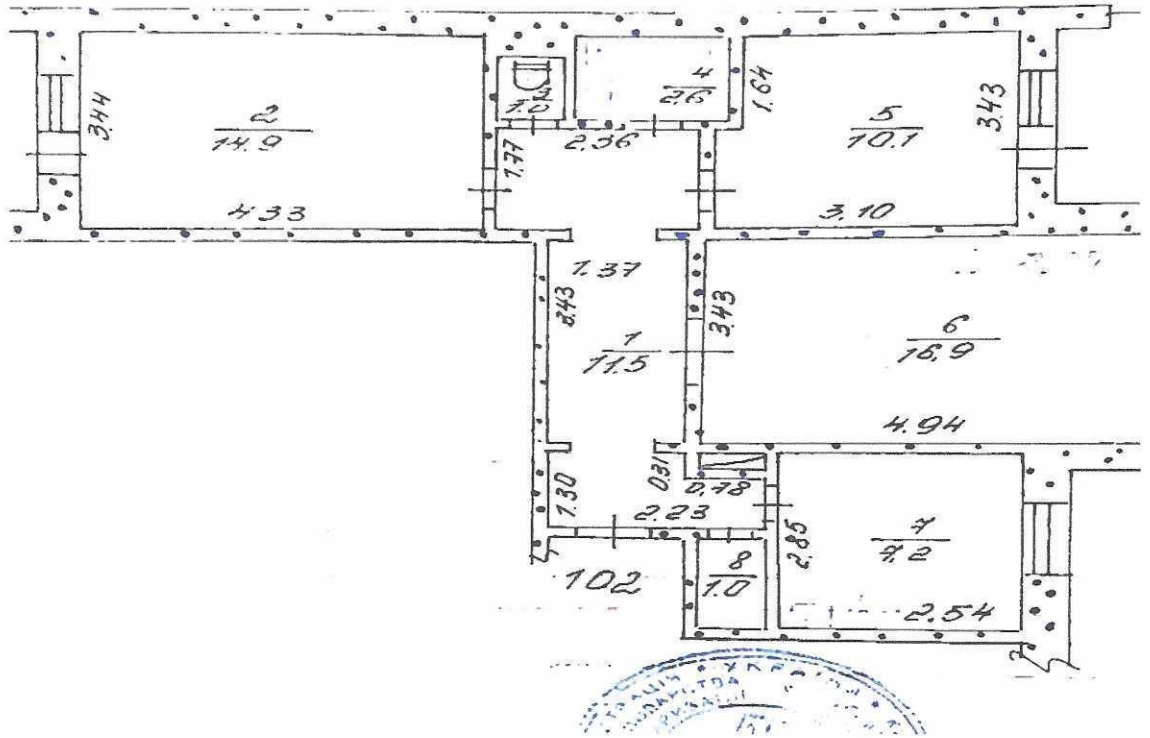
План квартиры 102 будинок 61 поверх 8
